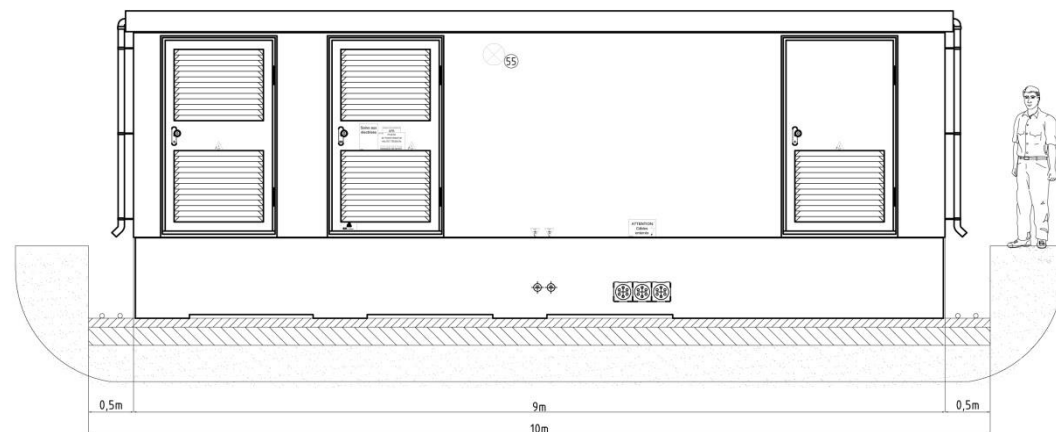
Plan de façade d'un poste de livraison (vue de face)
